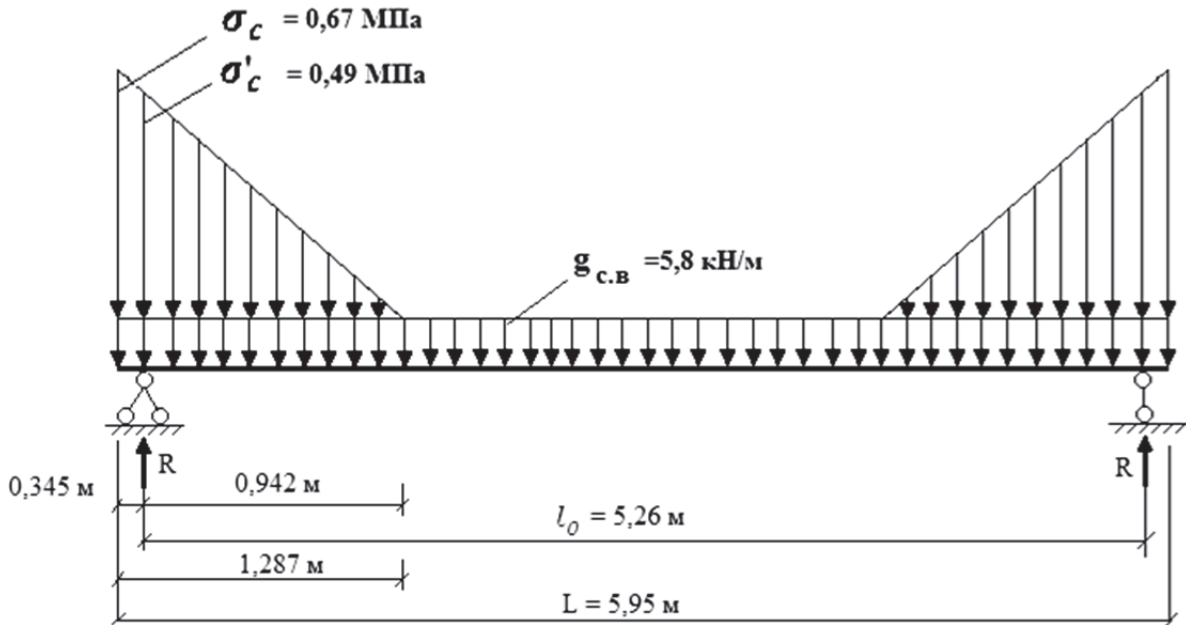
Расчётная схема и нагрузки на фундаментную балку
